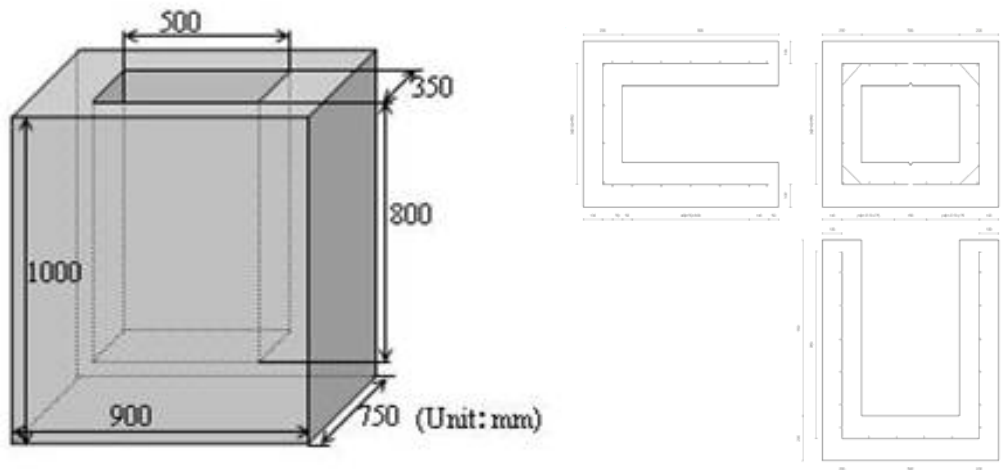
ひび割れ通水試験用桁形 RC 試験体（コンクリート使用量：約 0.5m<sup>3</sup>）
